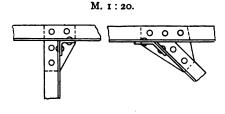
215. Anschluß zweier L-Eisen. M. 1:20.
